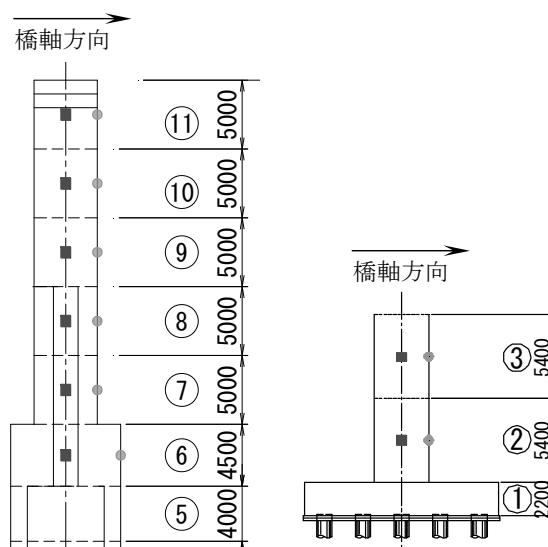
クーリングパイプ概略配置図 (P11, P12, P13 橋脚)
